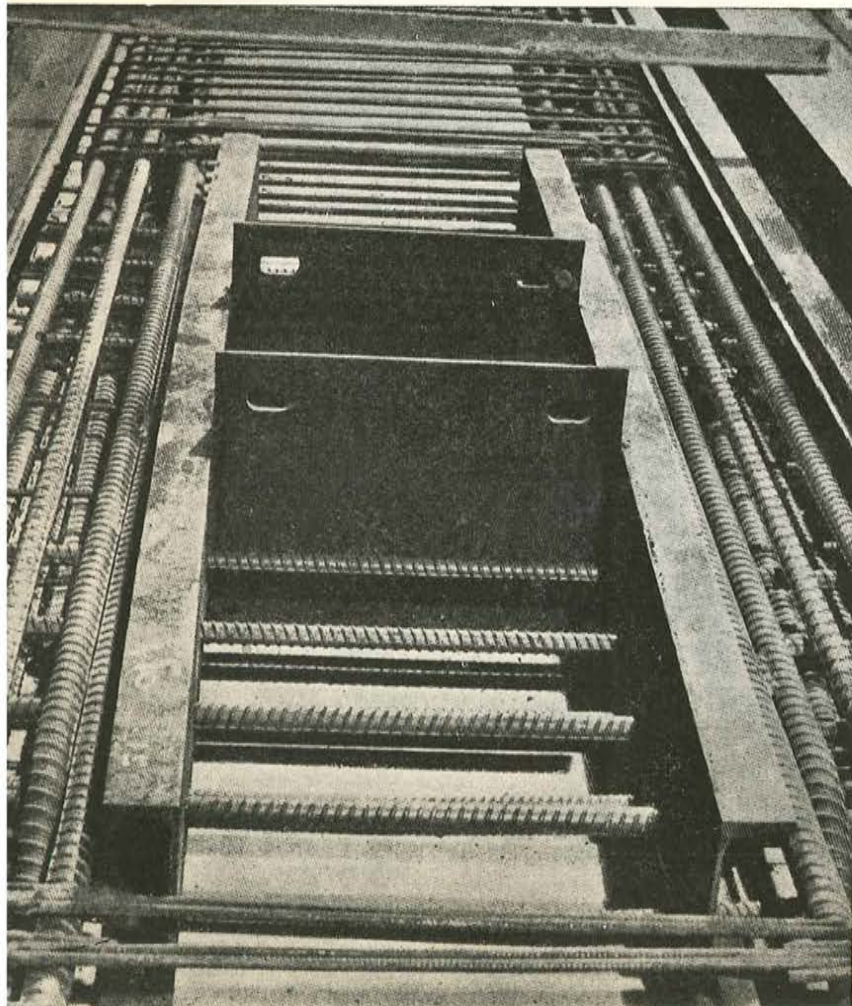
Armadura de una de las vigas prefabricadas de arriostamiento, dentro del encofrado y antes de hormigonar.
